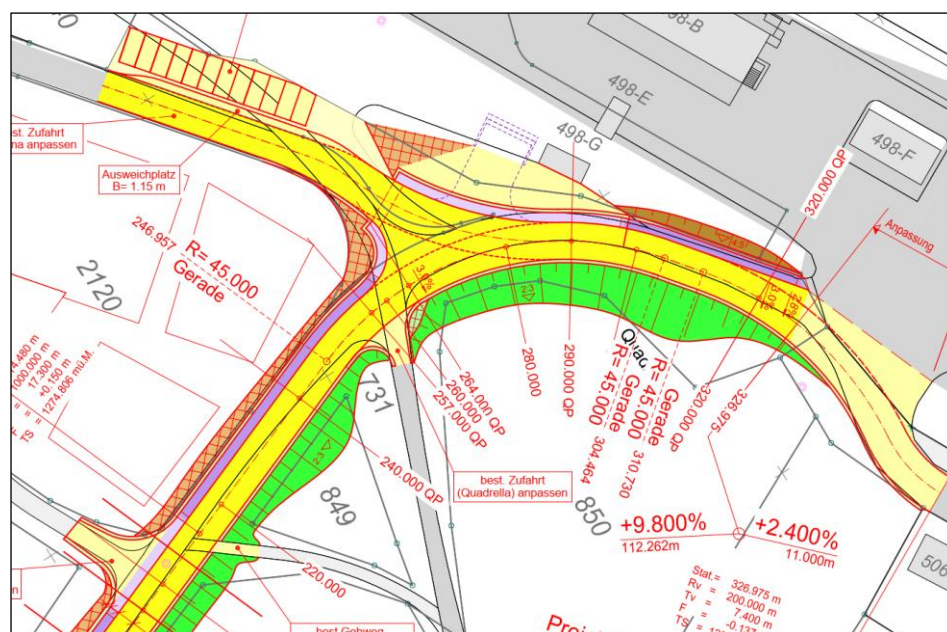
Projekt Sanierung Via da Tarasp und Anschlusswerk Erschliessungsstrasse
